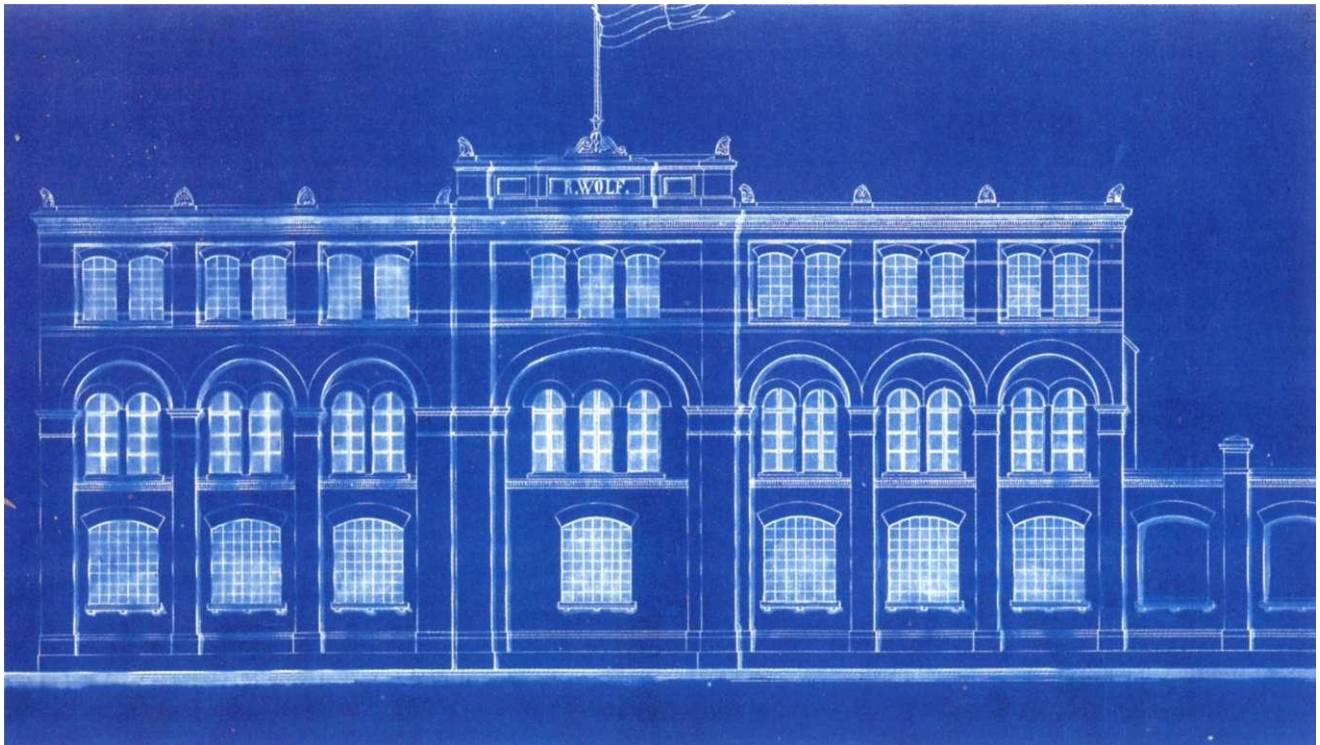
Karl-Schmidt-Straße 12, Fassadenaufriß 1885
